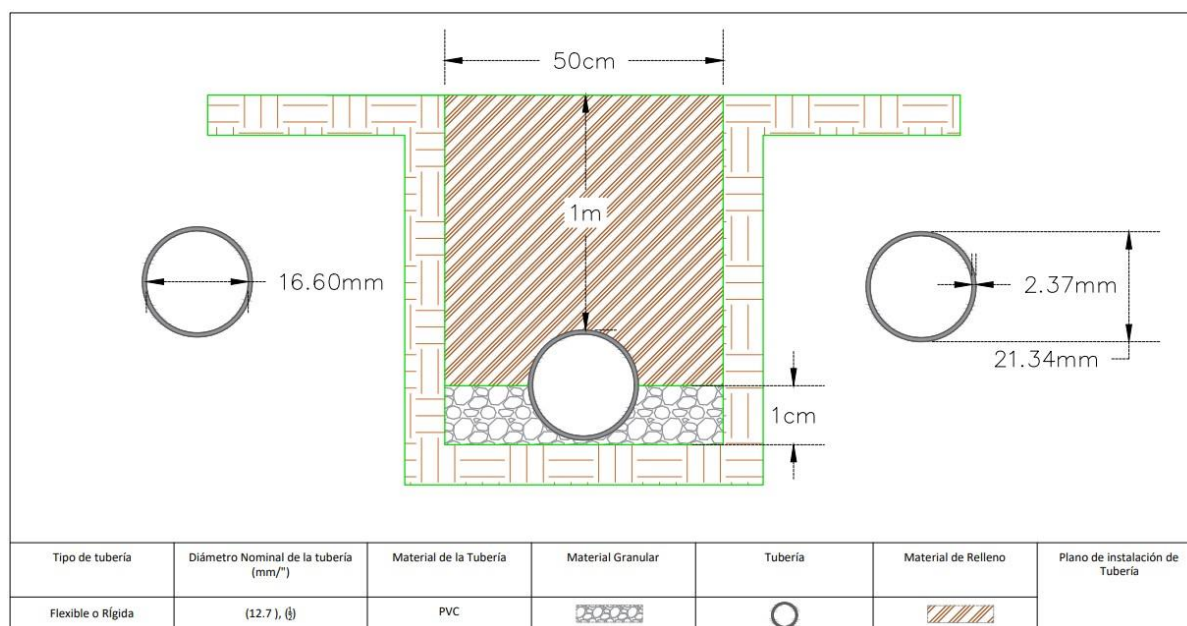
Plano de instalación de tubería; Fuente: (Carreño, 2023)
